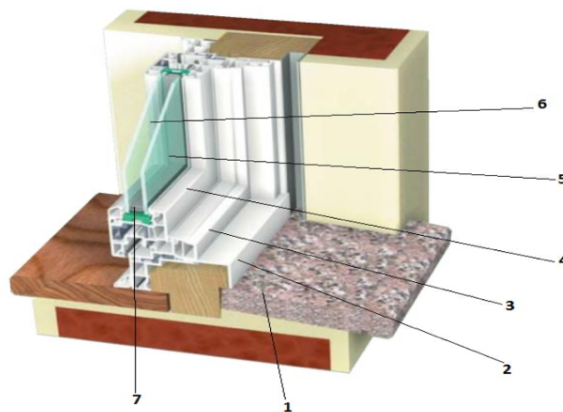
Elementos constituintes de um vão envidraçado [43]
